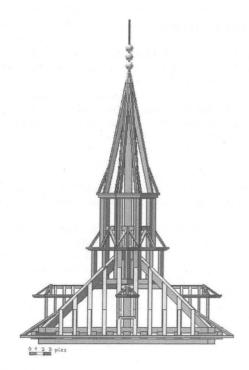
Alzado de la armadura del chapitel con los pináculos (Dibujo del autor)
